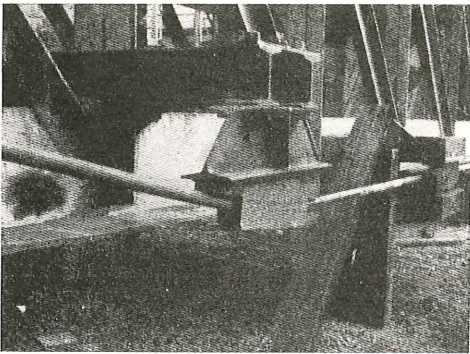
Dispositivo de cambio de dirección, de armaduras de pretensar, exentas.
